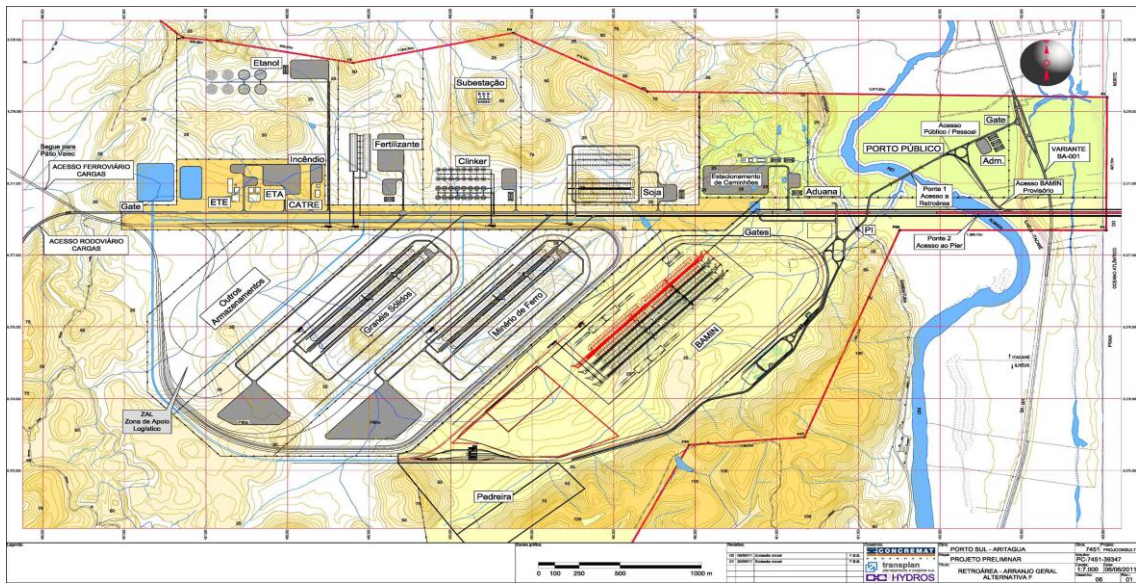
PORTO SUL – LAY-OUT PROPOSTO
